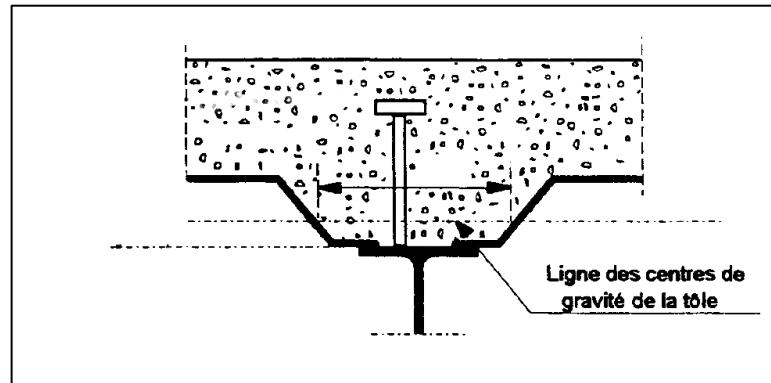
Schéma représentatif de la connexion entre la poutre et la dalle en béton
